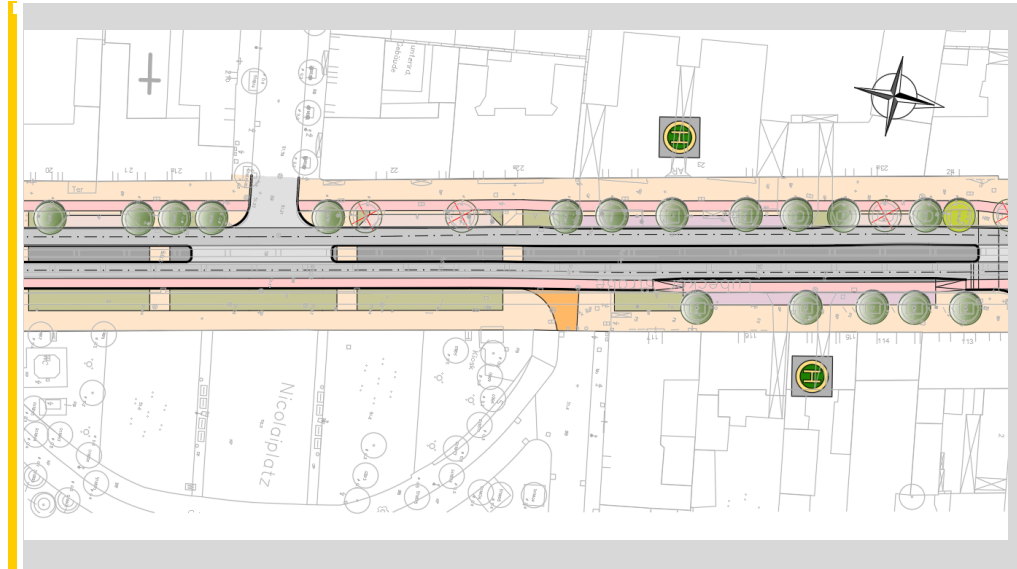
Lübecker Straße Mitte, Lageplanausschnitt V3
